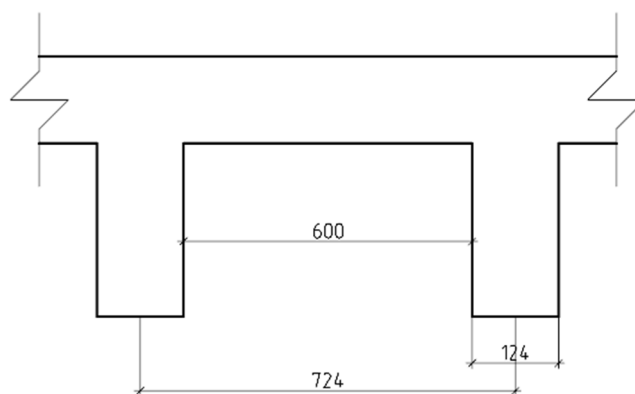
Сборно-монолитное перекрытие системы «МАРКО»
